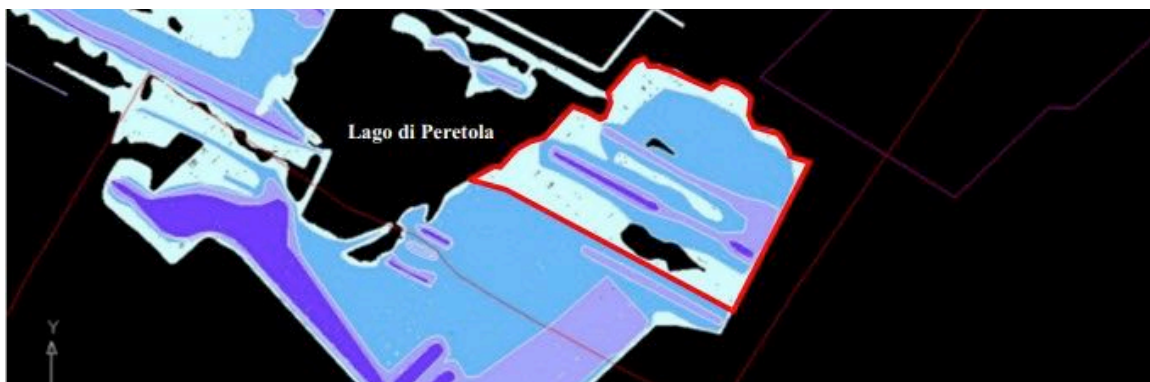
Aree di escavazione nel tratto di pista a sud-est del Lago di Peretola.
